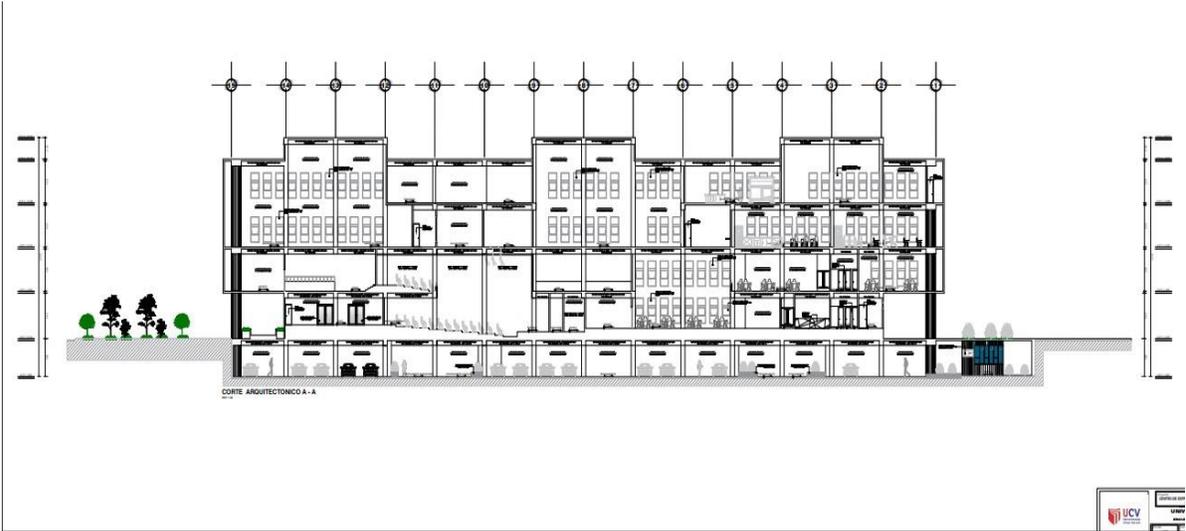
Plano Corte A-A Fuente: Elaboración Propia
